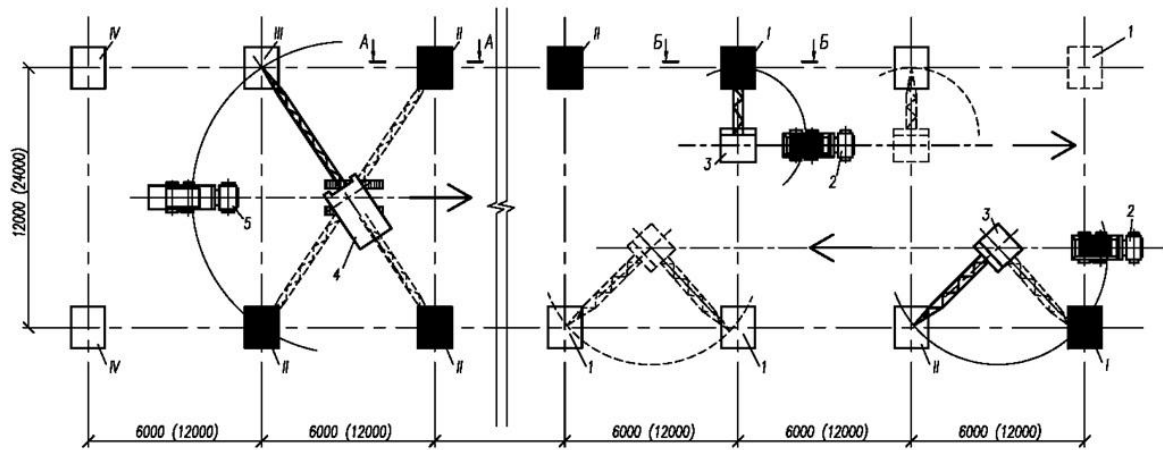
Схема бетонирования фундаментов с бермы откоса в общем котловане с помощью метода «кран-бадья» фундаментов с малым шагом (6 м)
